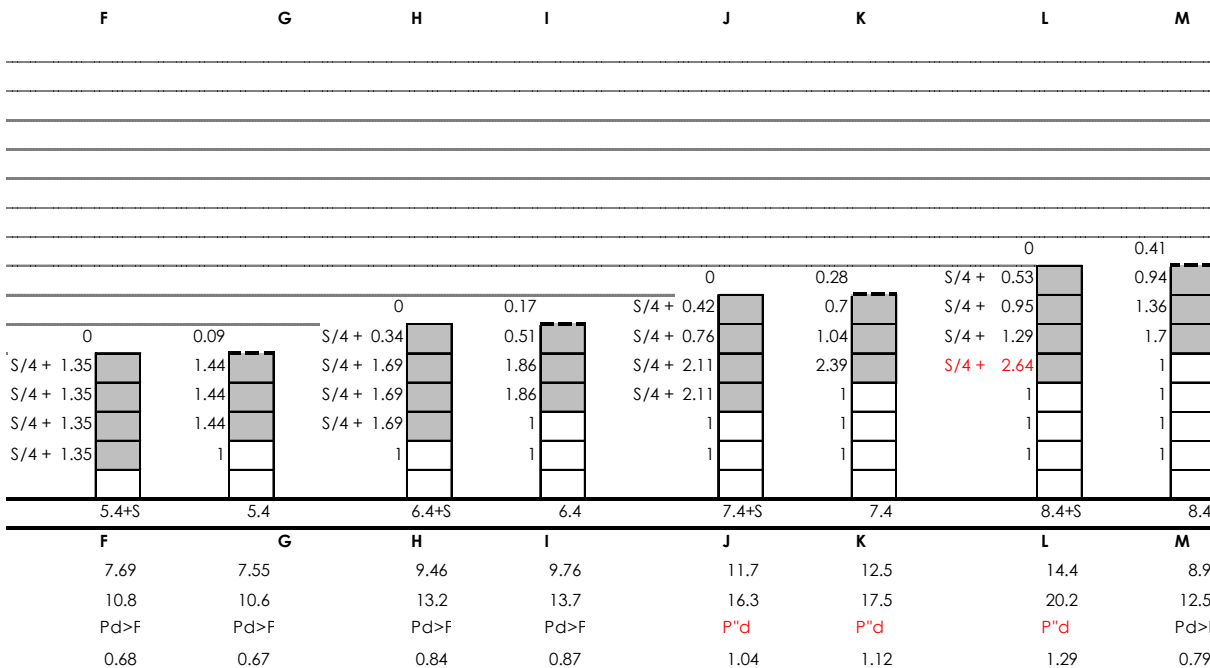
Losa Maciza. Ejecución 4 Cimbras 2/4
